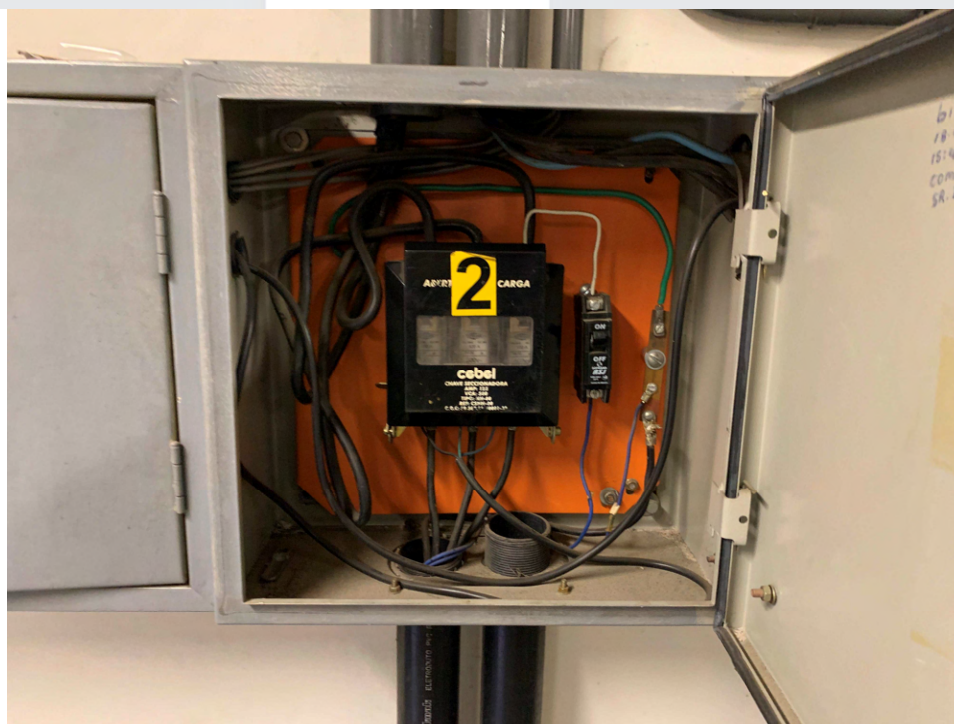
ALIMENTAÇÃO DOS EQUIPAMENTOS DA CASA DE MÁQUINAS DOS ELEVADORES
